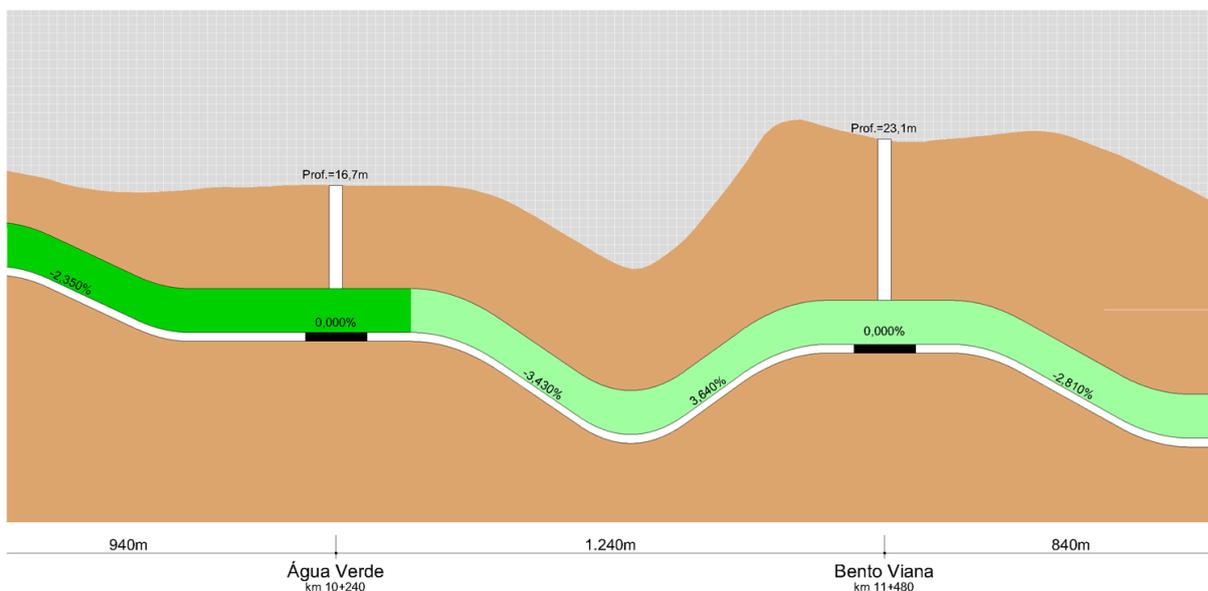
Perfil longitudinal – *cut and cover* e NATM.
